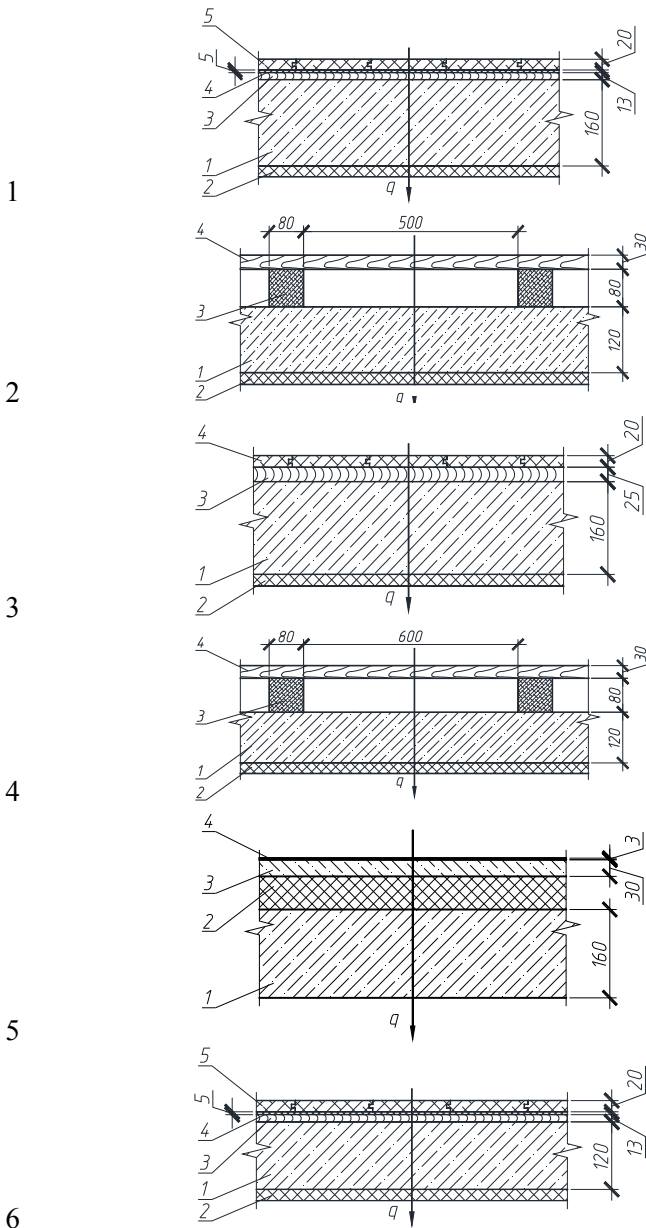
Варианты конструкции перекрытия над техническим подпольем
